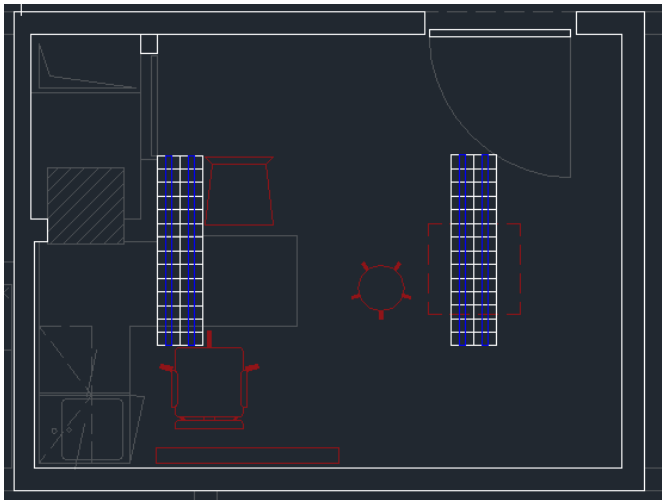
Planta Autocad do Gabinete de Consulta Externa
